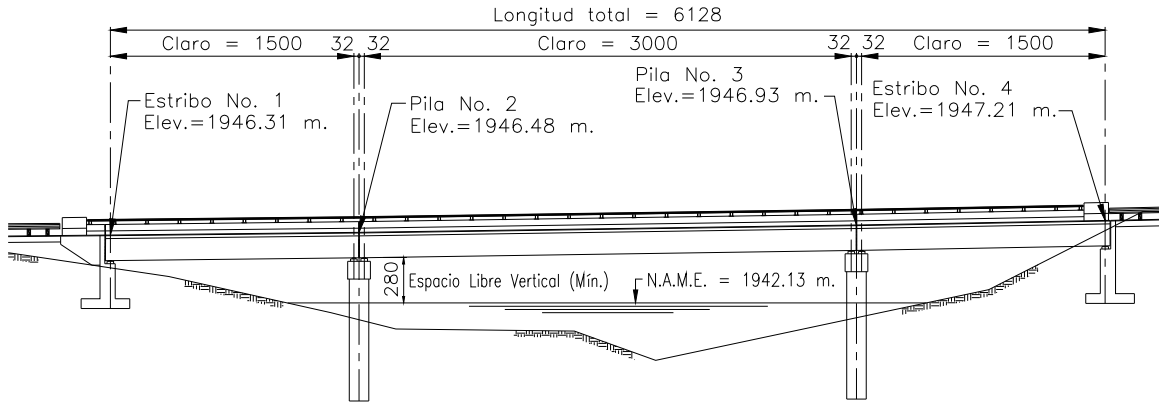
Corte en Elevación por el Eje de Trazo.
